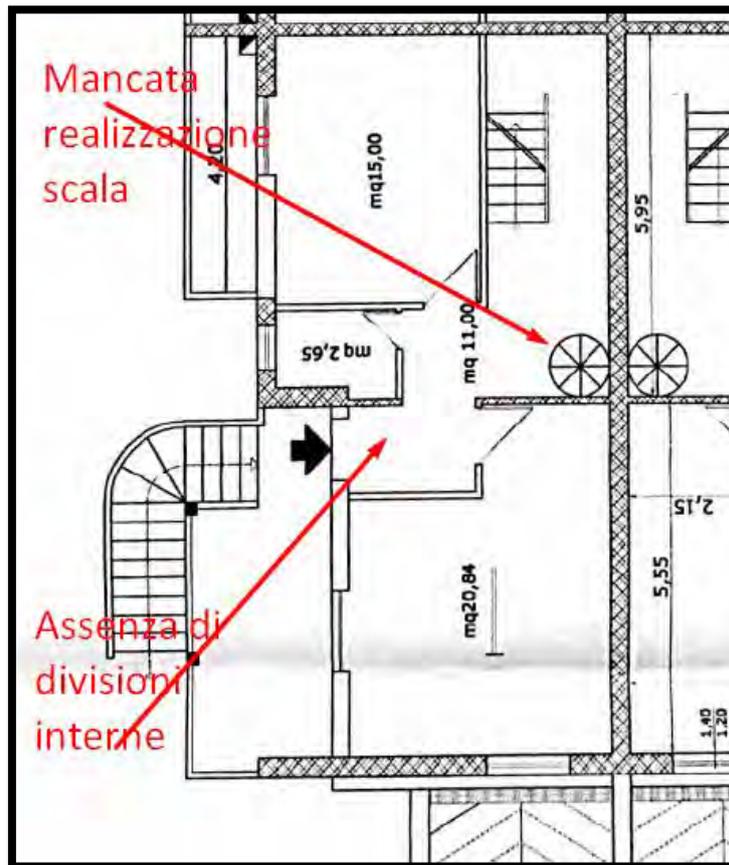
Pianta piano primo allegata alla CILA prat. n. 294/2011
